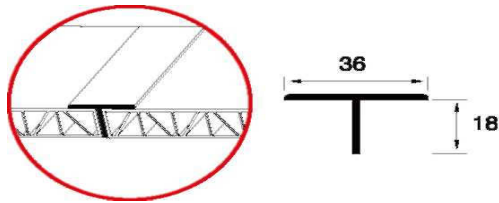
Pladeck ile köşe teşkili ve profil elemanı
